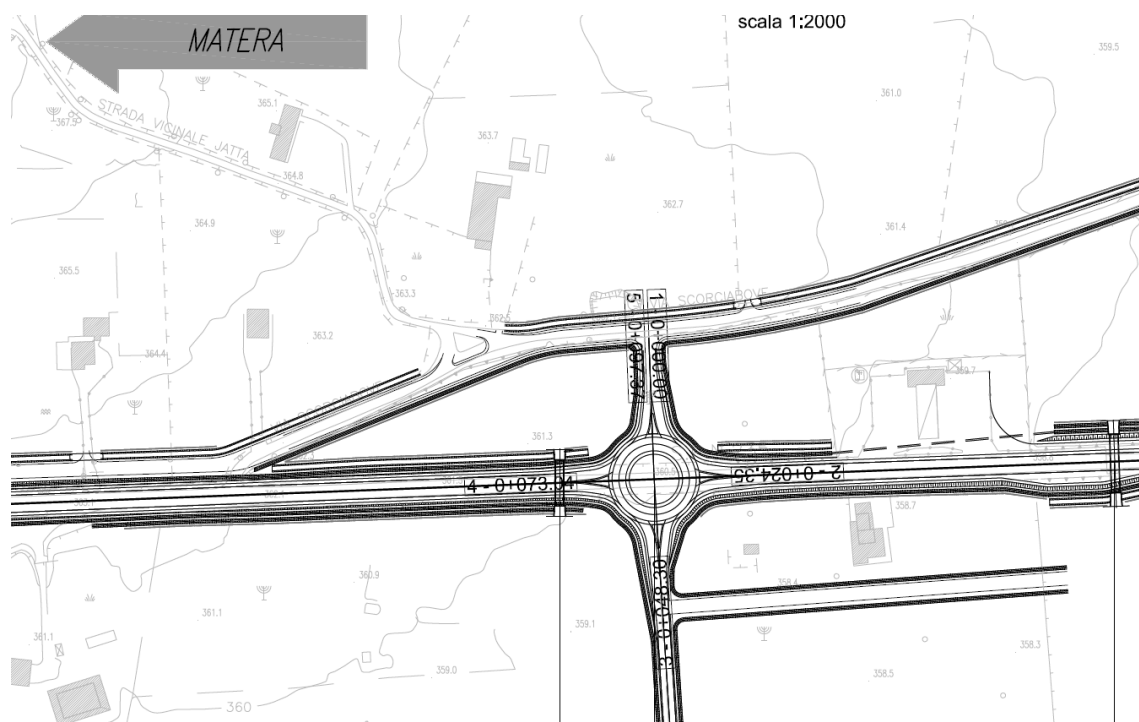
Planimetria di progetto Rotatoria 2- Km 1+512,48
